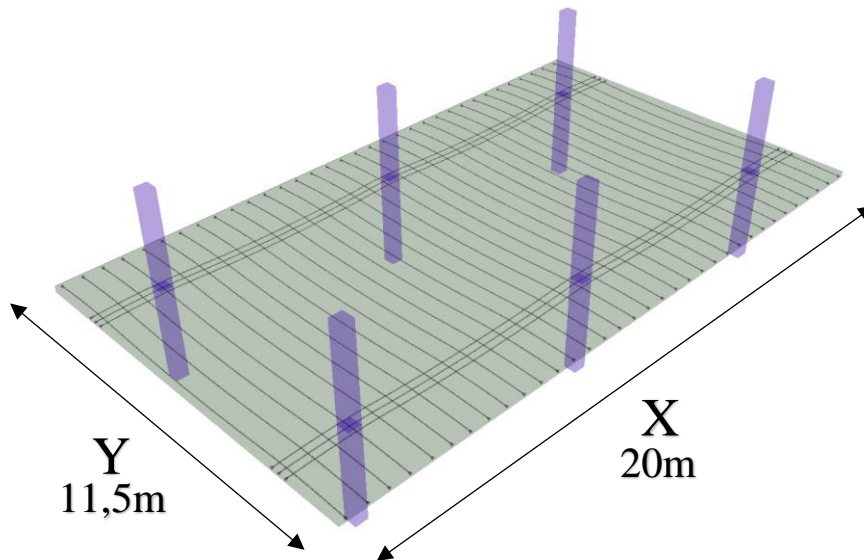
Layout do pavimento tipo. (Autor, 2019)
